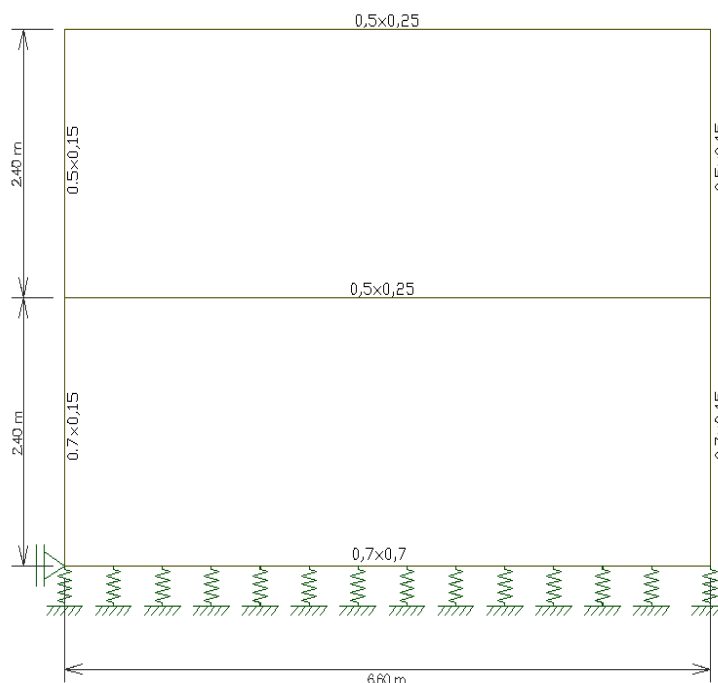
Dimensões e geometria das vigas e pilares do pórtico 6-6'
